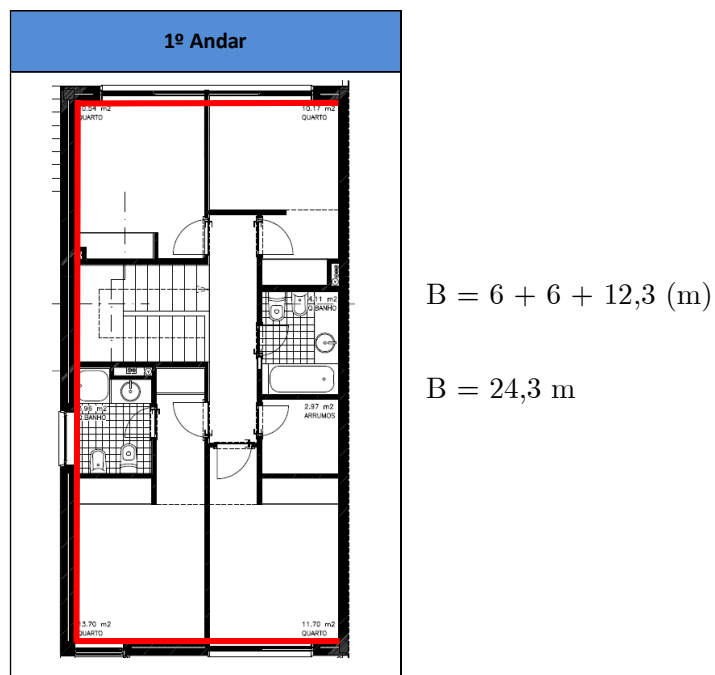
Ponte térmica linear de Fachada com cobertura.
